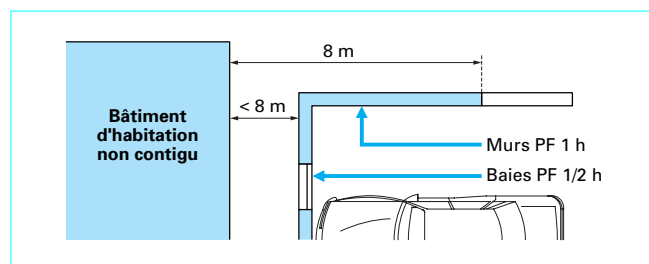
Isolement entre parc et façade d'un bâtiment non contigu
